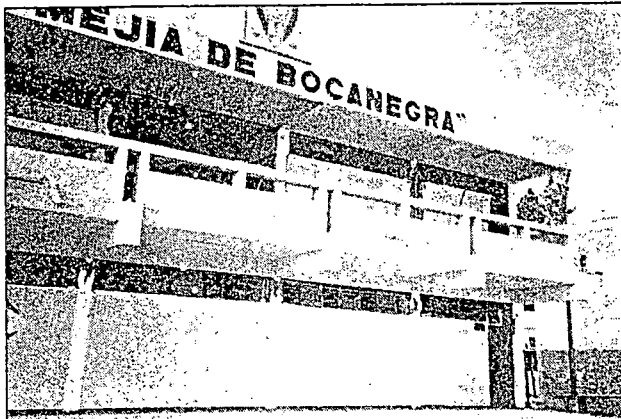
Instituto Pedagógico Josefina Mejía de Bocanegra. Nasca. Edificio de dos pisos de concreto armado. Falla por corte en casi todas las columnas de ambos pisos que acertadas por los alféizares adosados a ellas.
